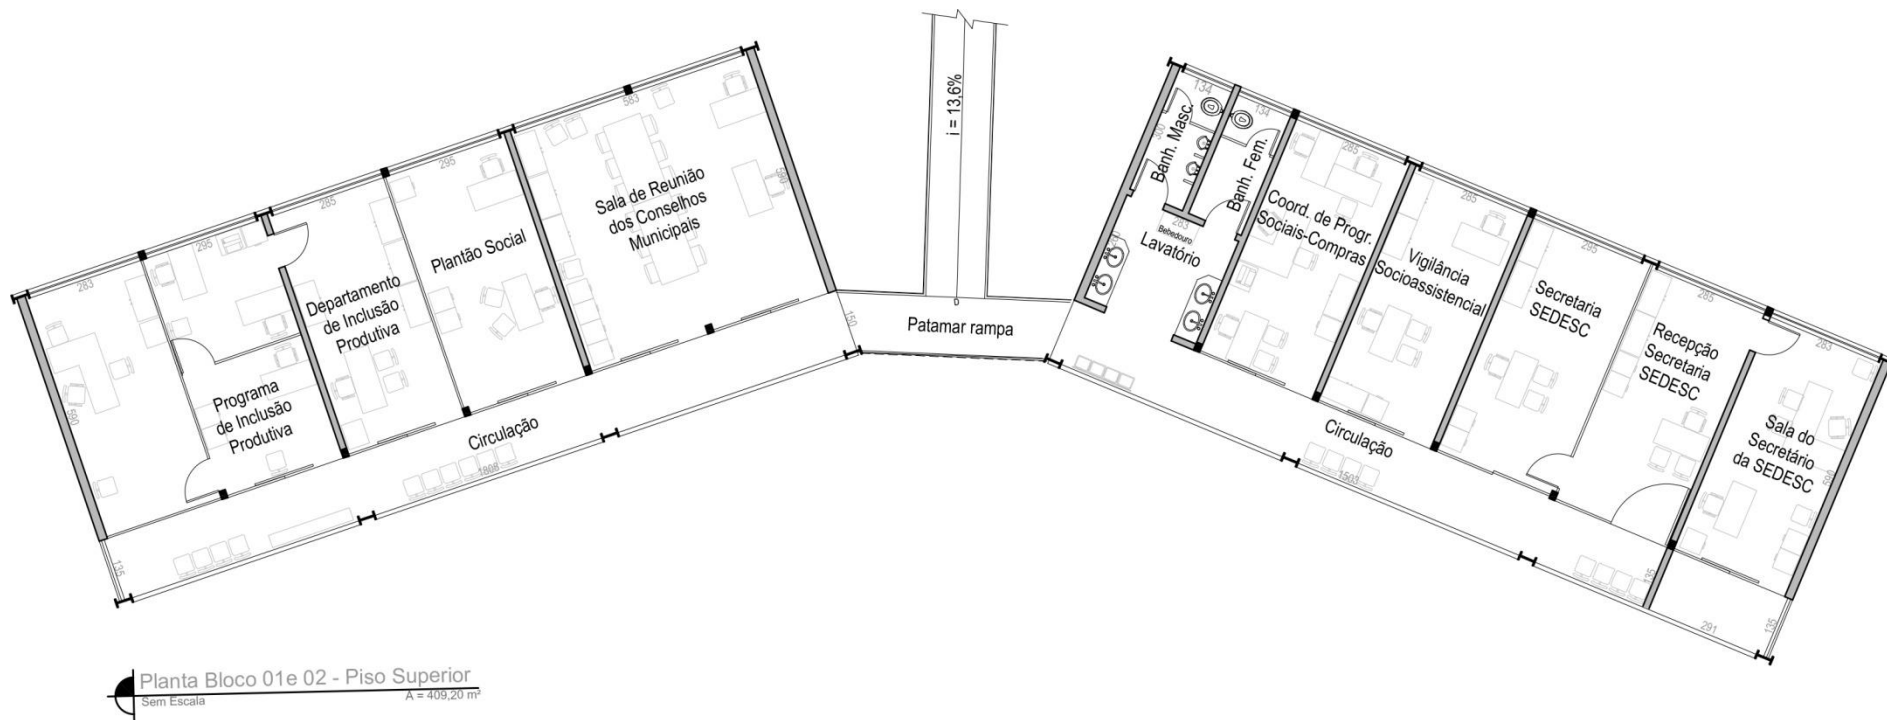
Planta Baixa com Layout do Segundo Pavimento da SEDESC.
